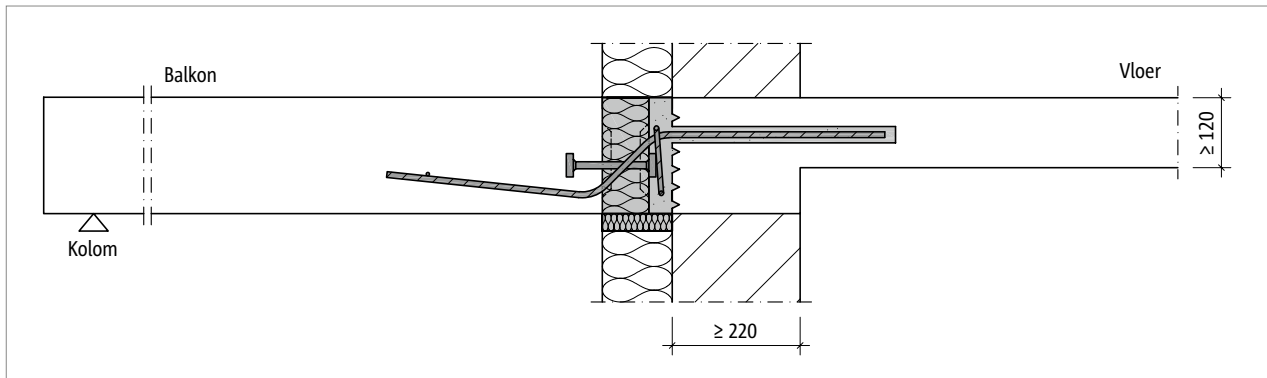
Schöck Isokorb® RT type SQ: Barrièrevrije overgang door hoogteverschil
